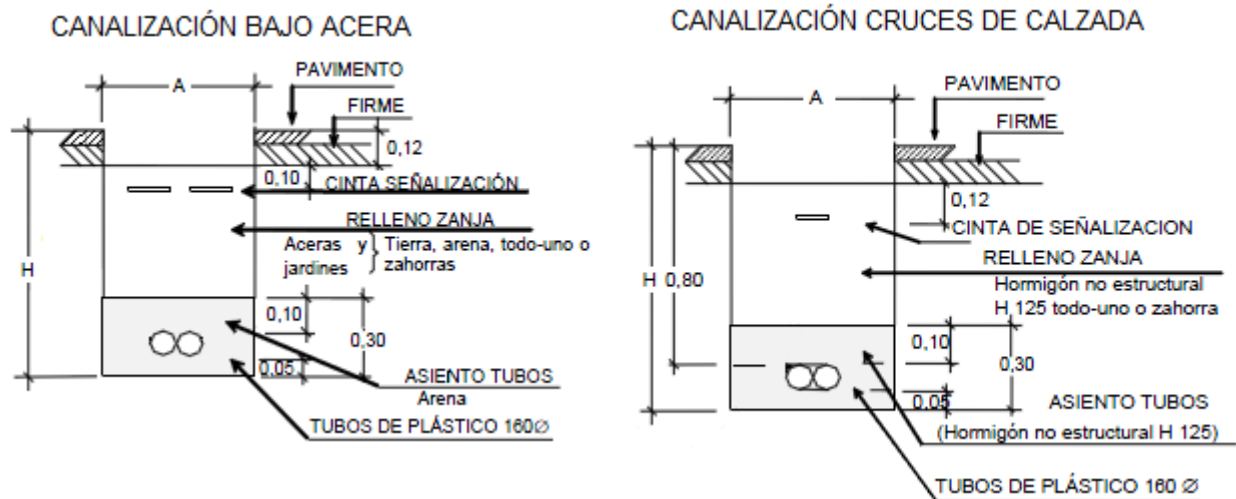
Detalle canalización media tensión bajo acera y en cruces de calzada
